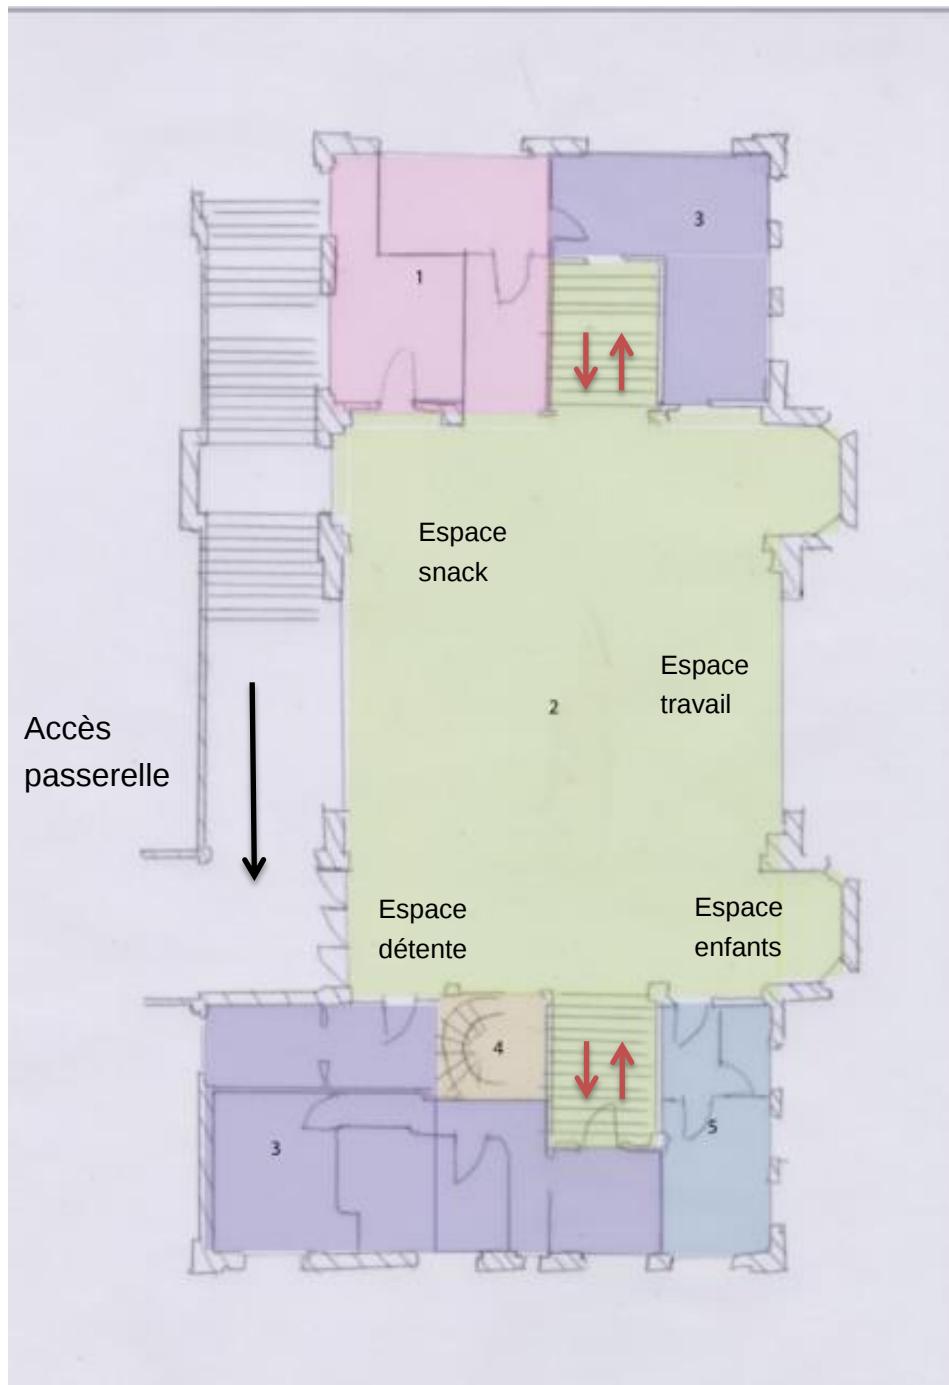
Proposition du nouveau plan du 1er étage – Réalisation Jade DOUGERE/ Adobe Illustrator
